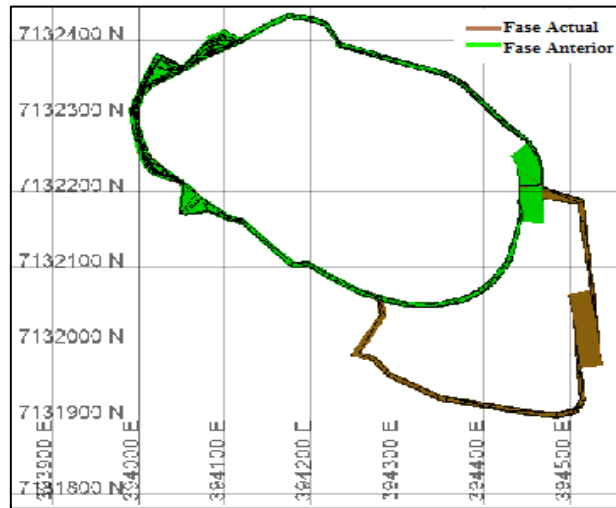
LG1Y Fase 5 - Vista en sección - Planta banco LI080
